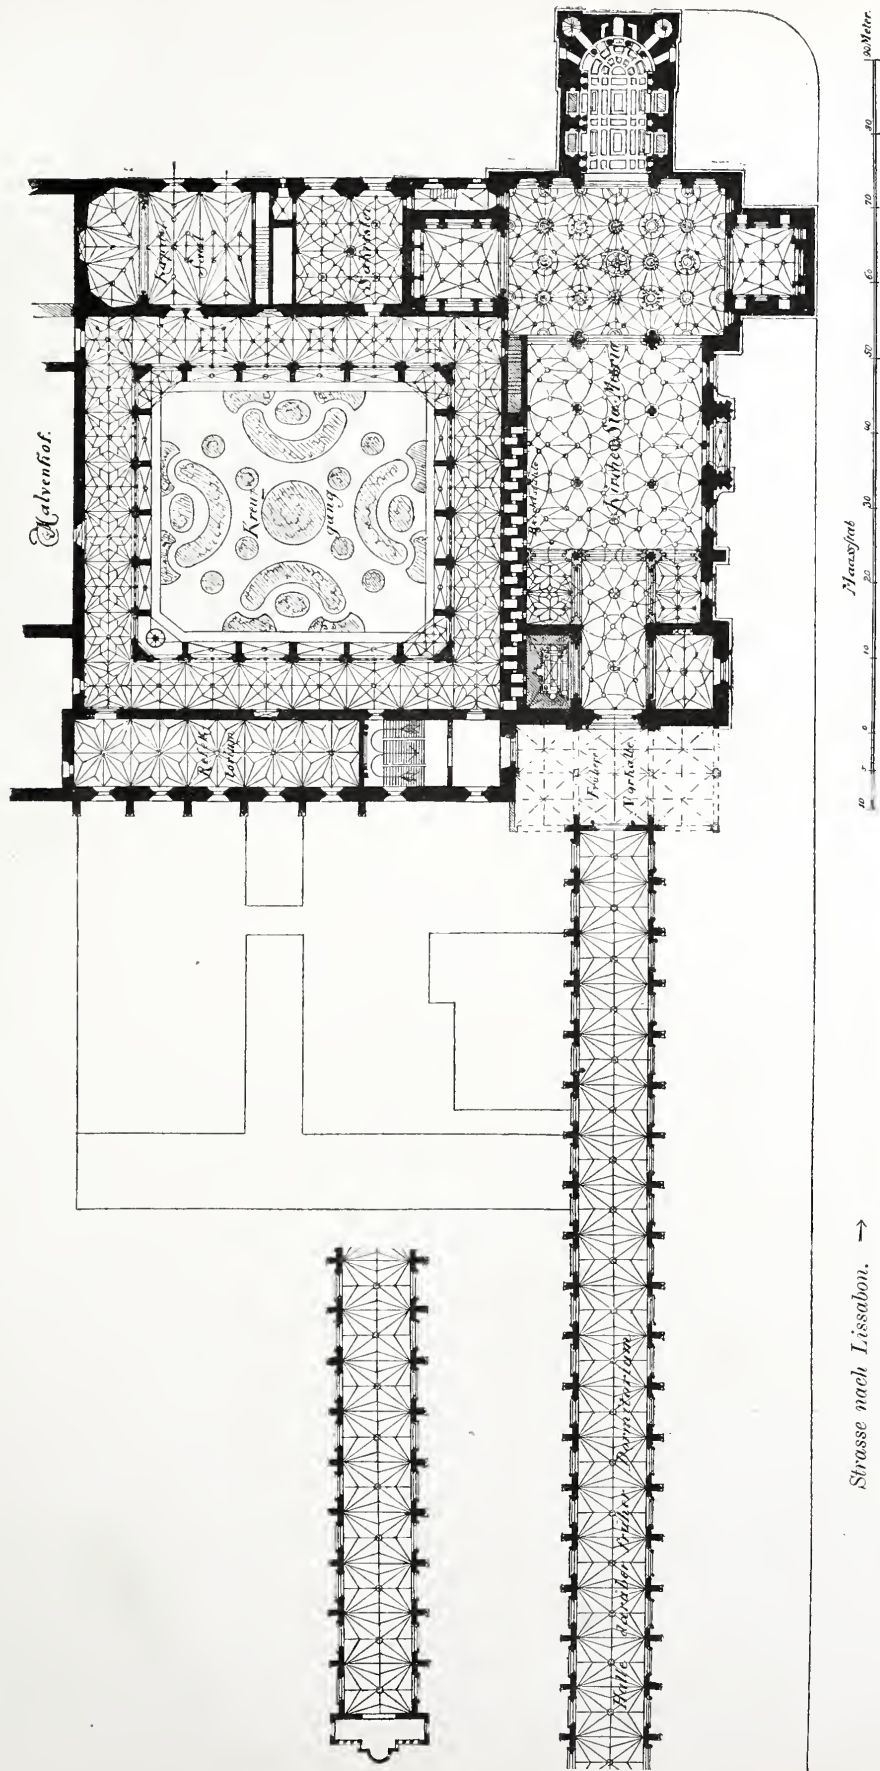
Grundriss des Klosters des Jeronimos zu Belem.
